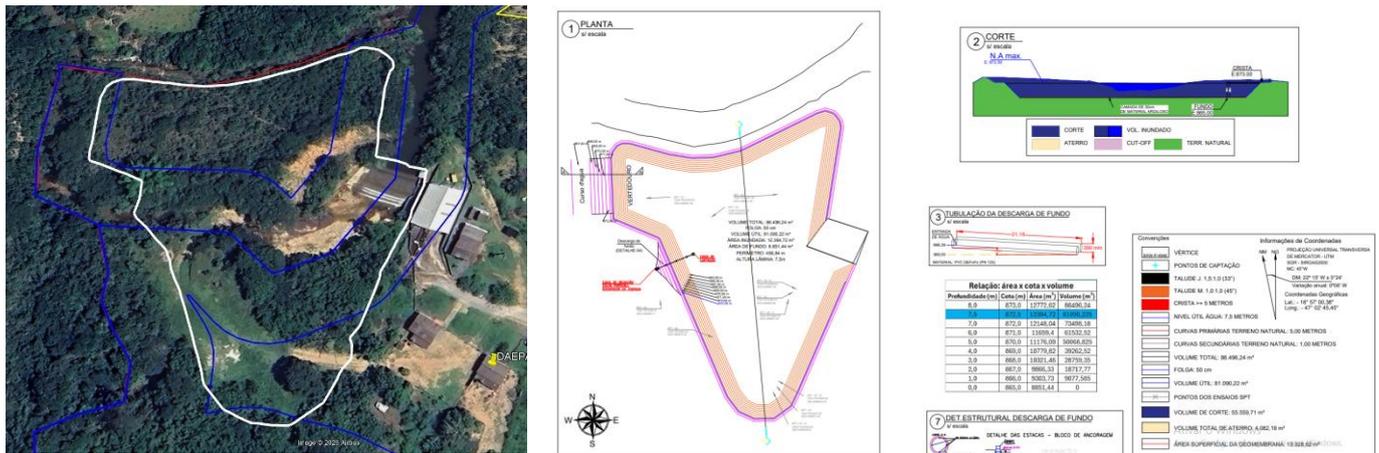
Área de intervenção ambiental requerida em branco. Corte do projeto estrutural apresentado
